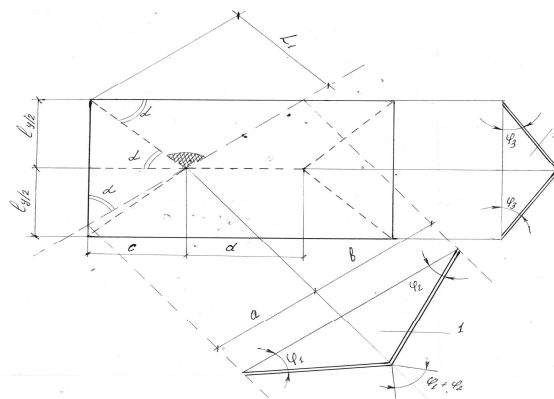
Расчетная схема излома сборных железобетонных плит перекрытий методом предельного равновесия
